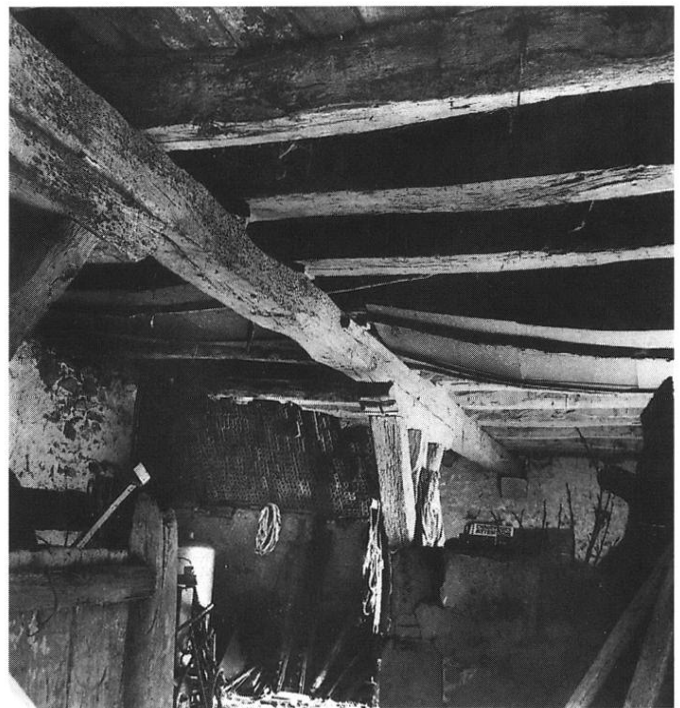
Rez de chaussée au nord- Grande salle- Plancher et cours de poutres vue vers le nord. (Ph. D. Bontemps Cl. M. H.)
